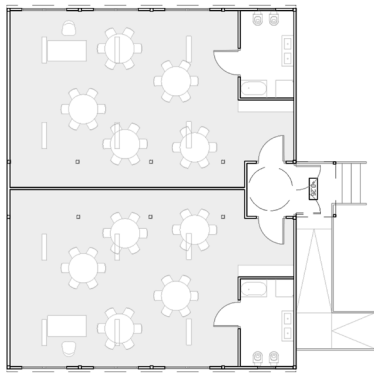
Planimetría de aula tipo colegio de educación infantil temporal "Caracolas" en Utrera (Sevilla). Fuente: Elaboración propia.
